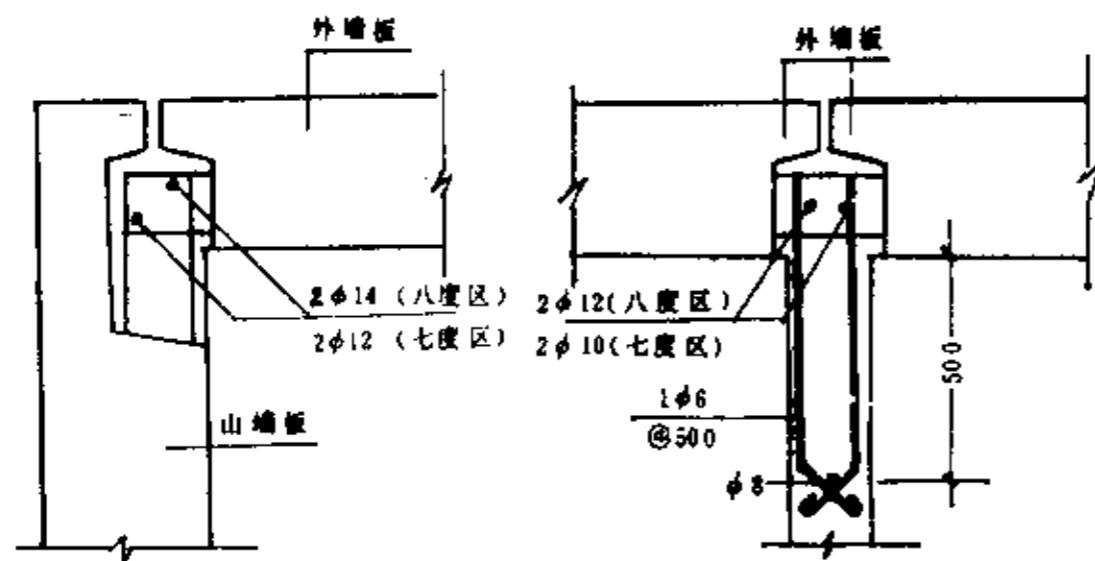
外墙角联结构造图 图 5.0.4-2 内外墙联结构造图
